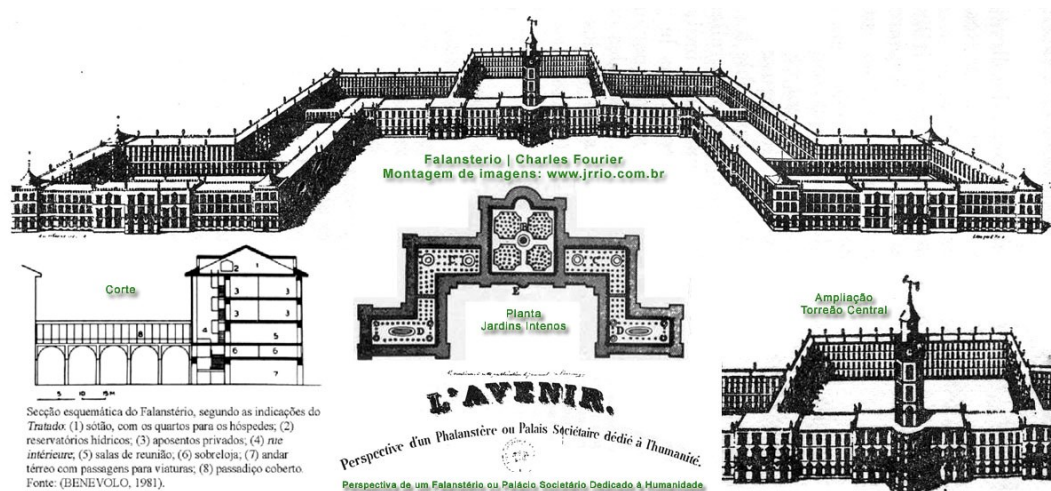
Il Falansterio: vista in prospettiva e in pianta.
